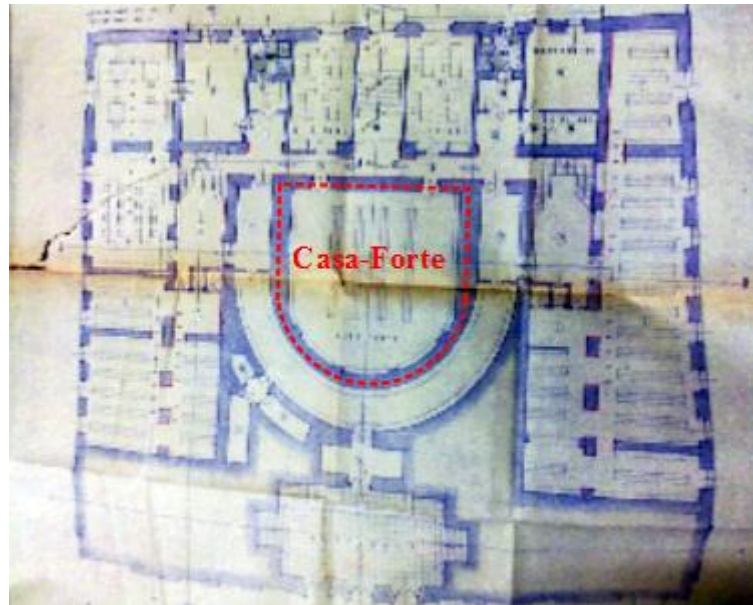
Localização da Casa-Forte na planta da cave da BGUC.
